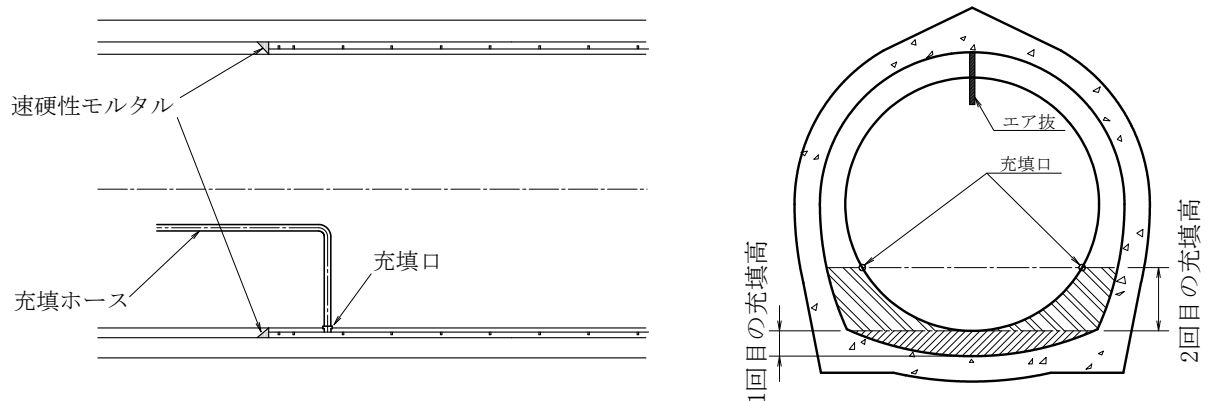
裏込充填工の縦断面図・横断面図（例）
